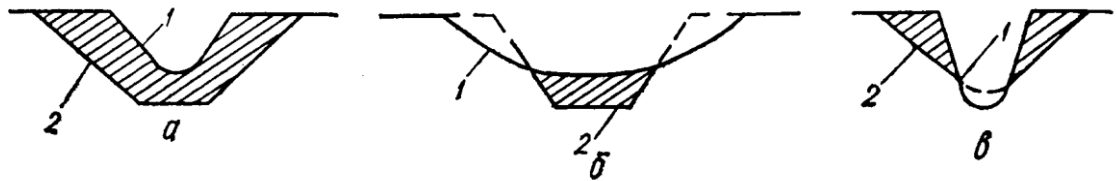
Збільшення поперечного перерізу існуючого русла водоприймача
